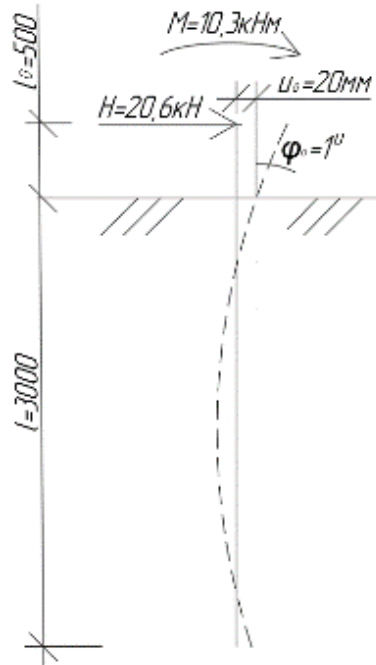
Схема нагрузок, приходящих на односвайно-плитный фундамент
